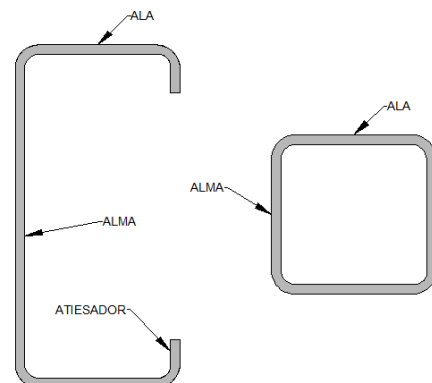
Elementos del perfil C (izquierda) y tubo estructural cuadrado (derecha). AutoCAD.
